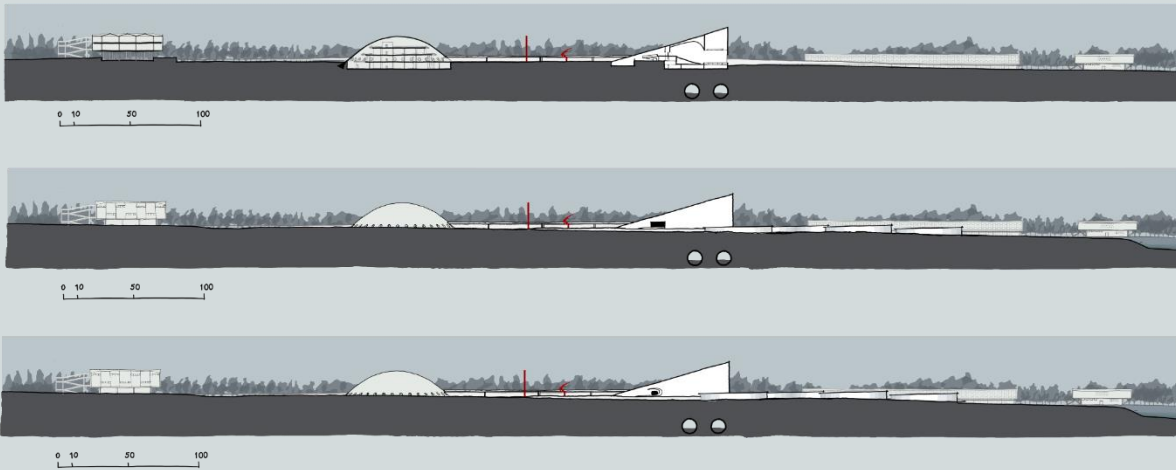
Implantação – 2002 – Versão 04 A – desenho nosso.
